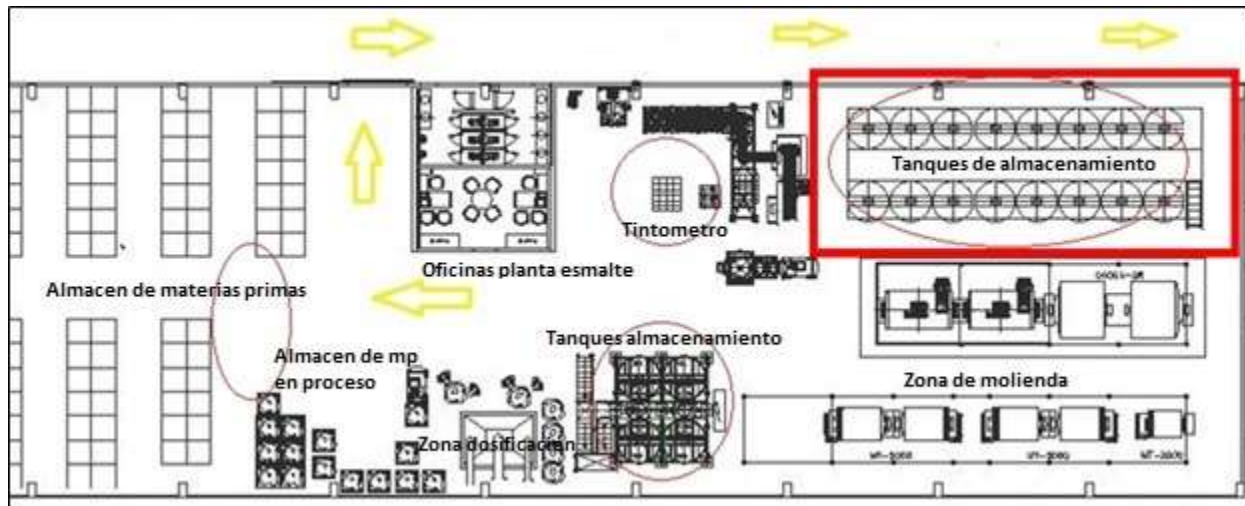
Layout actual de Planta Esmaltes y Líneas de Esmalte
